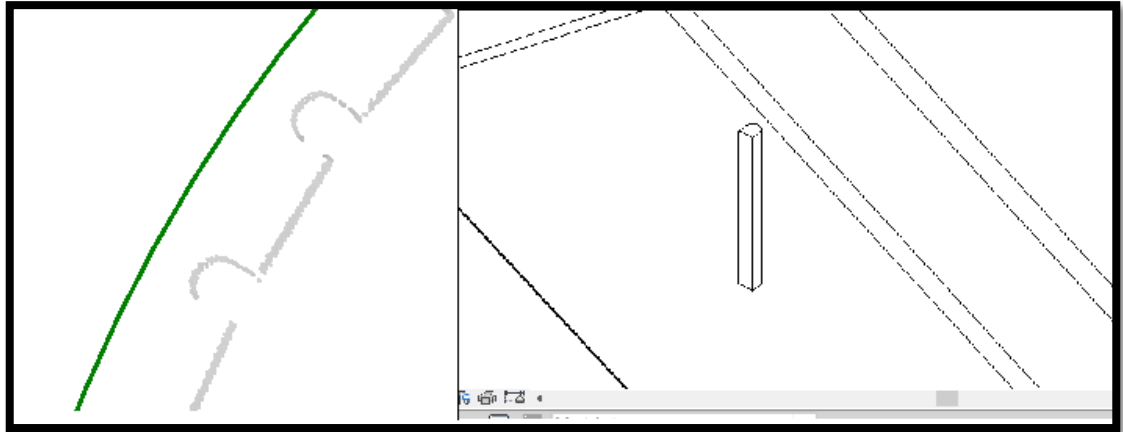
Ejemplo de columna de la azotea. (Fuente: propia Elaboración)
